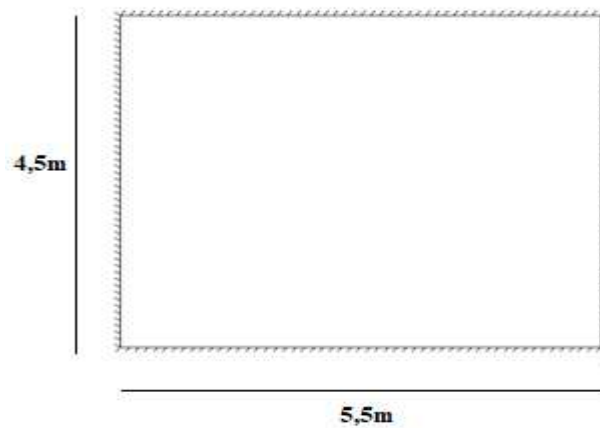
Dimensions d'une dalle pleine rectangulaire.
